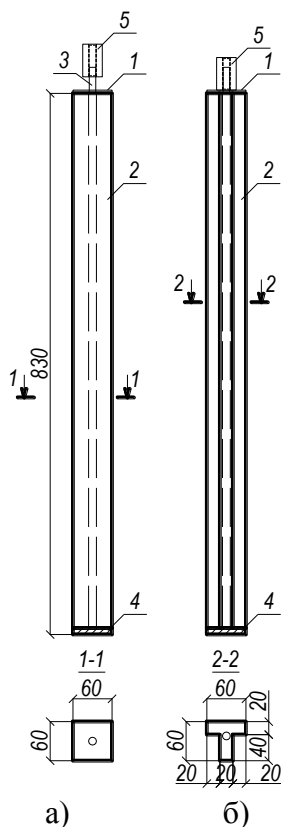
Моделі дослідних паль-штампів квадратної (а) і таврової (б) форми поперечного перерізу; 1 - металевий оголовок палі; 2 - дерев'яна бічна поверхня; 3 - шпилька; 4 - торець приварений до шпильки 3; 5 - металевий кругляк.
